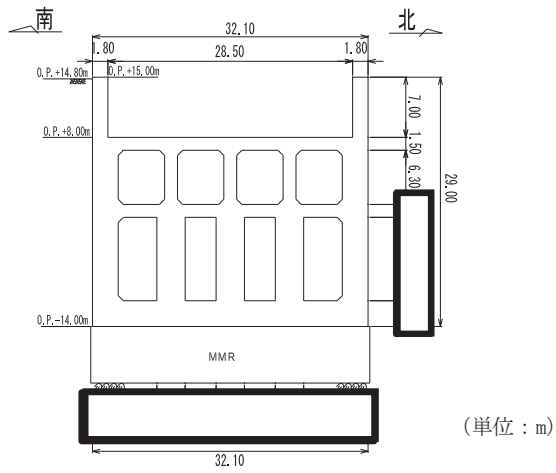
第 3 号機海水ポンプ室断面図 (A-A 断面)
